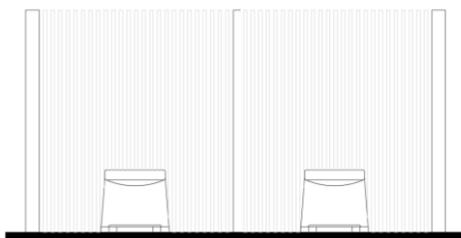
Colocación de aparato sanitario en baño seco. Fuente: Elaboración propia
